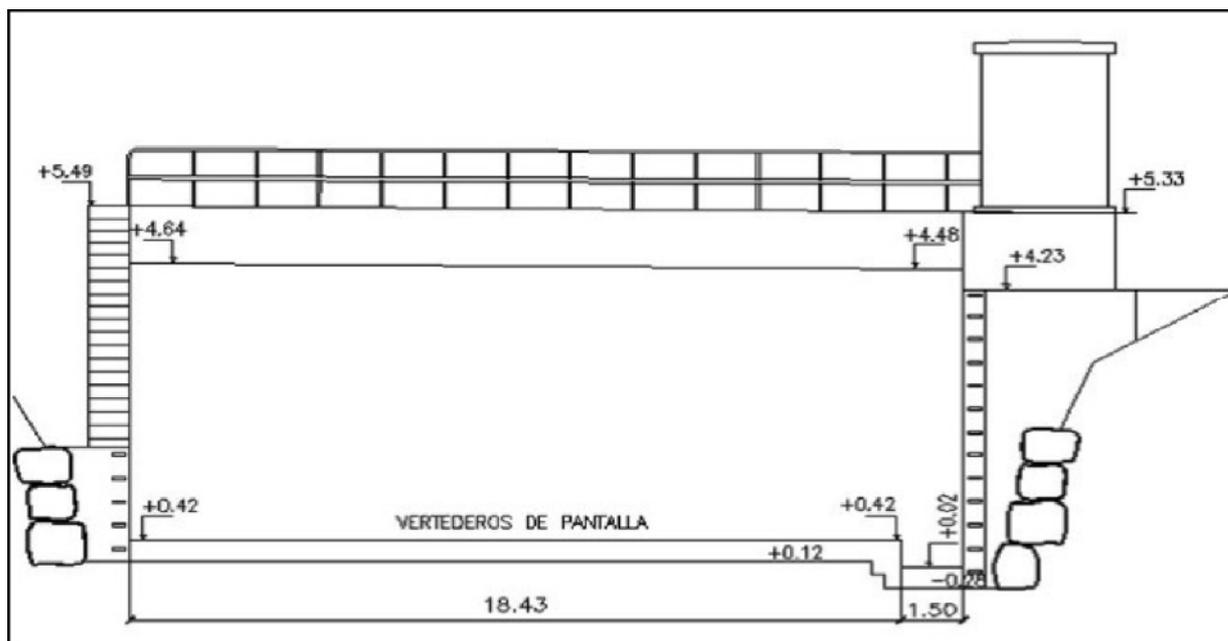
Croquis de la Sección de la Estación de aforos (Fuente CEDEX)
